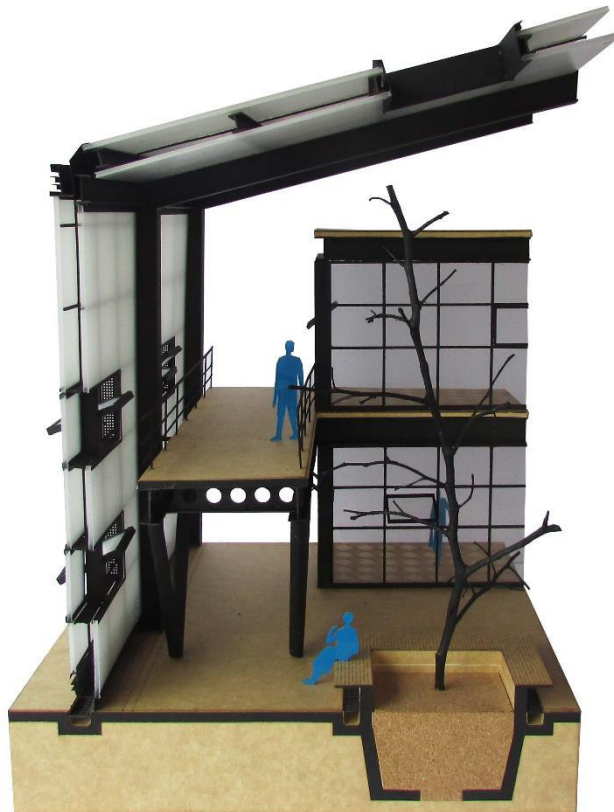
Maqueta de desarrollo constructivo - Propuesta arquitectónica.
